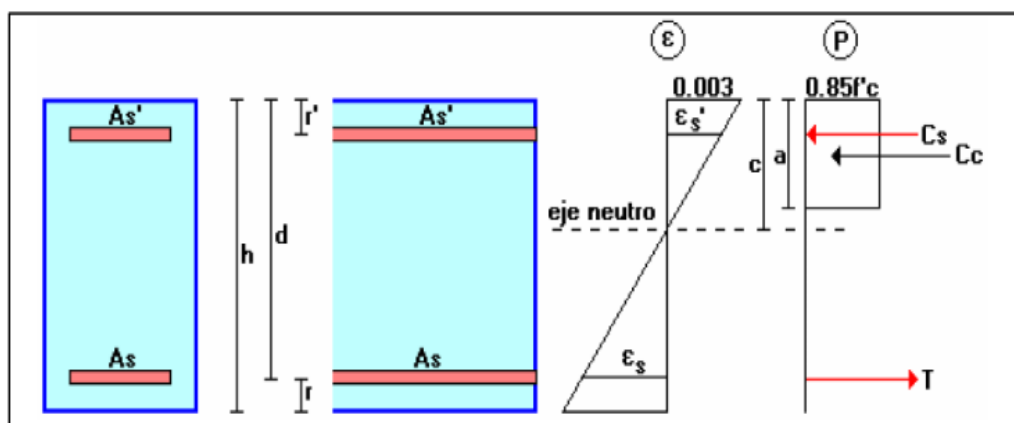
Deformaciones y esfuerzos en vigas rectangulares con armadura de tracción y de compresión.
